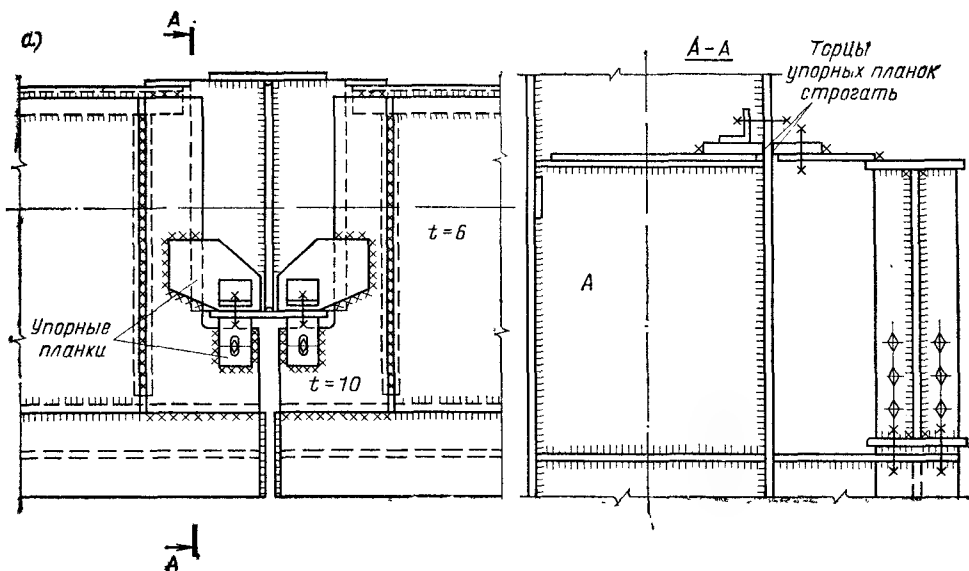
Узлы крепления разрезных подкрановых балок к колоннам
